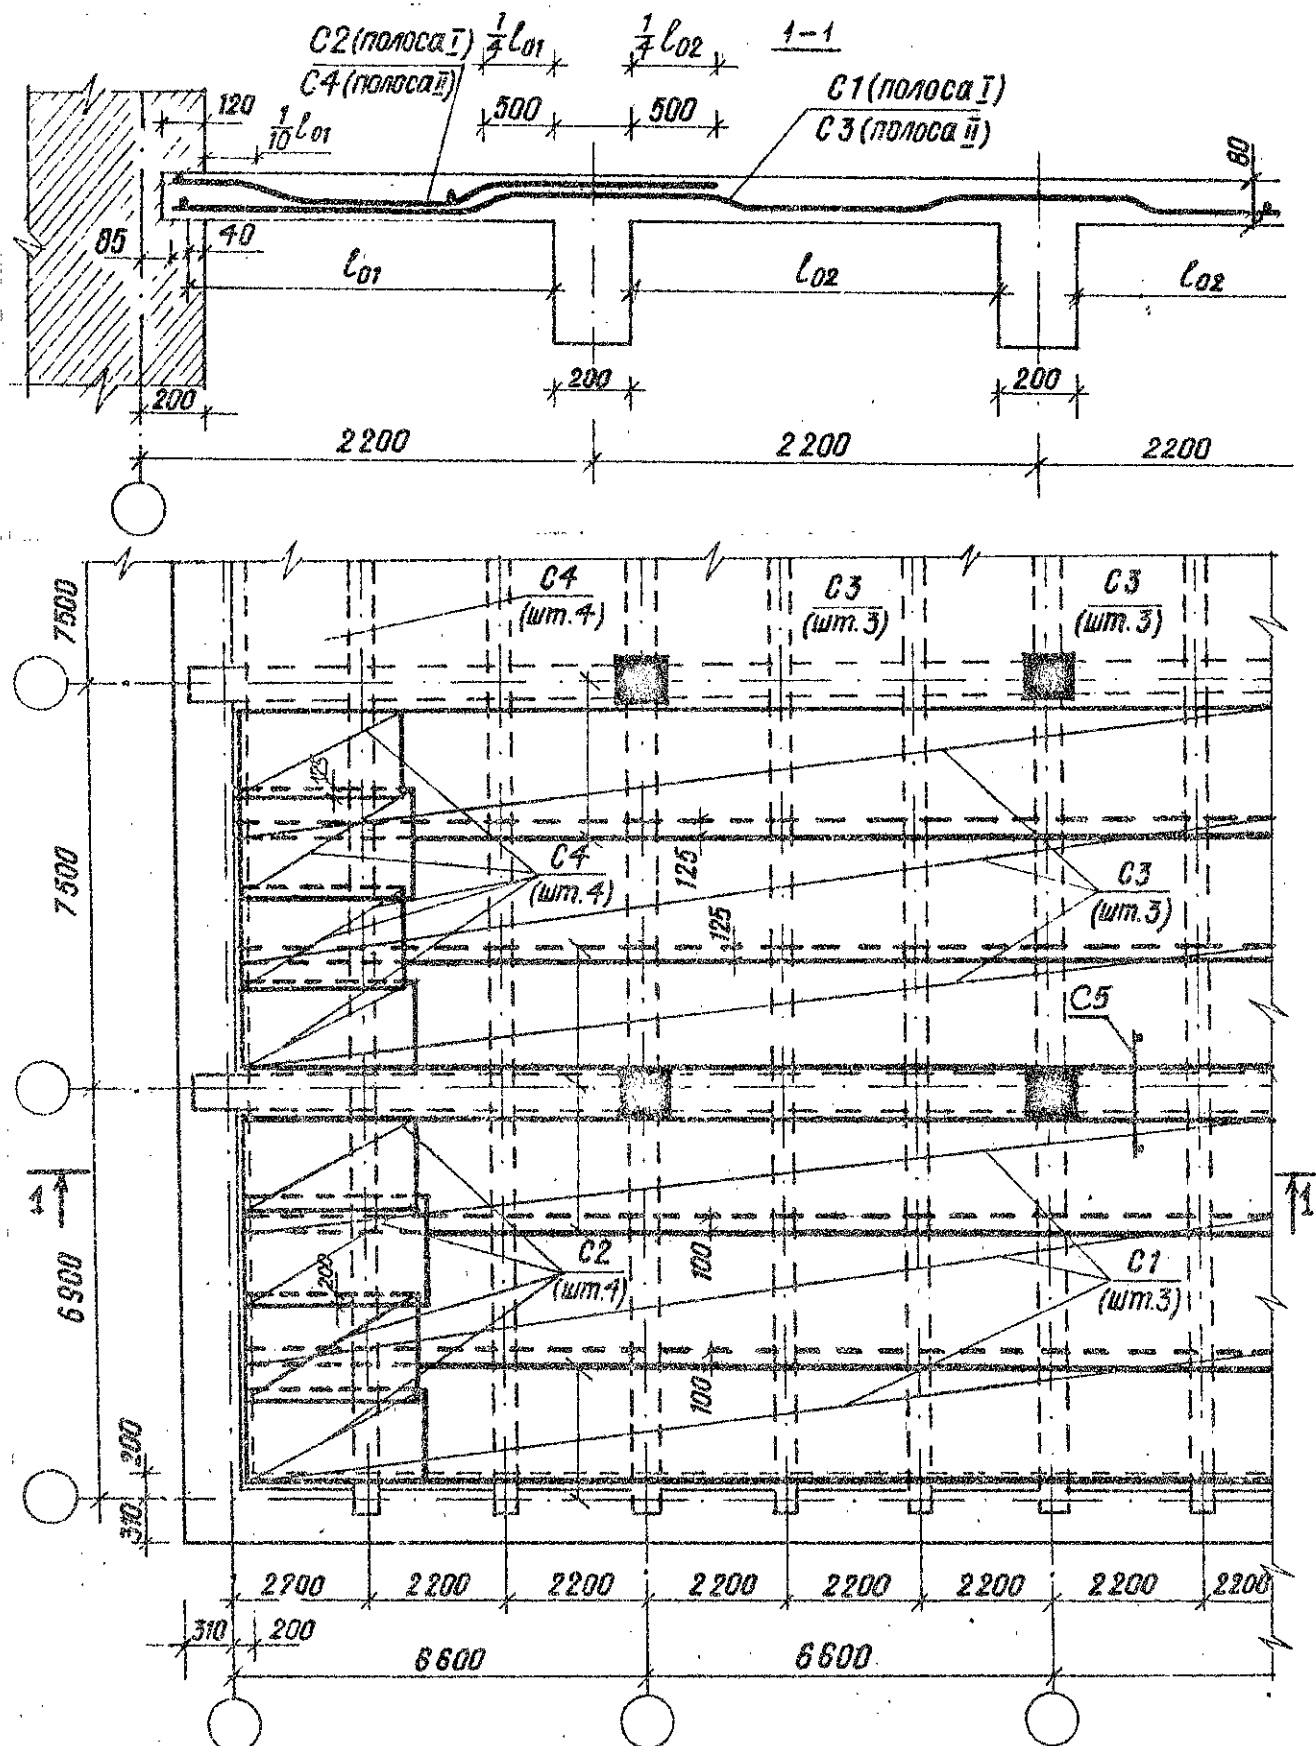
Армирование плиты оварными рулонными сетками с продольной рабочей арматурой
